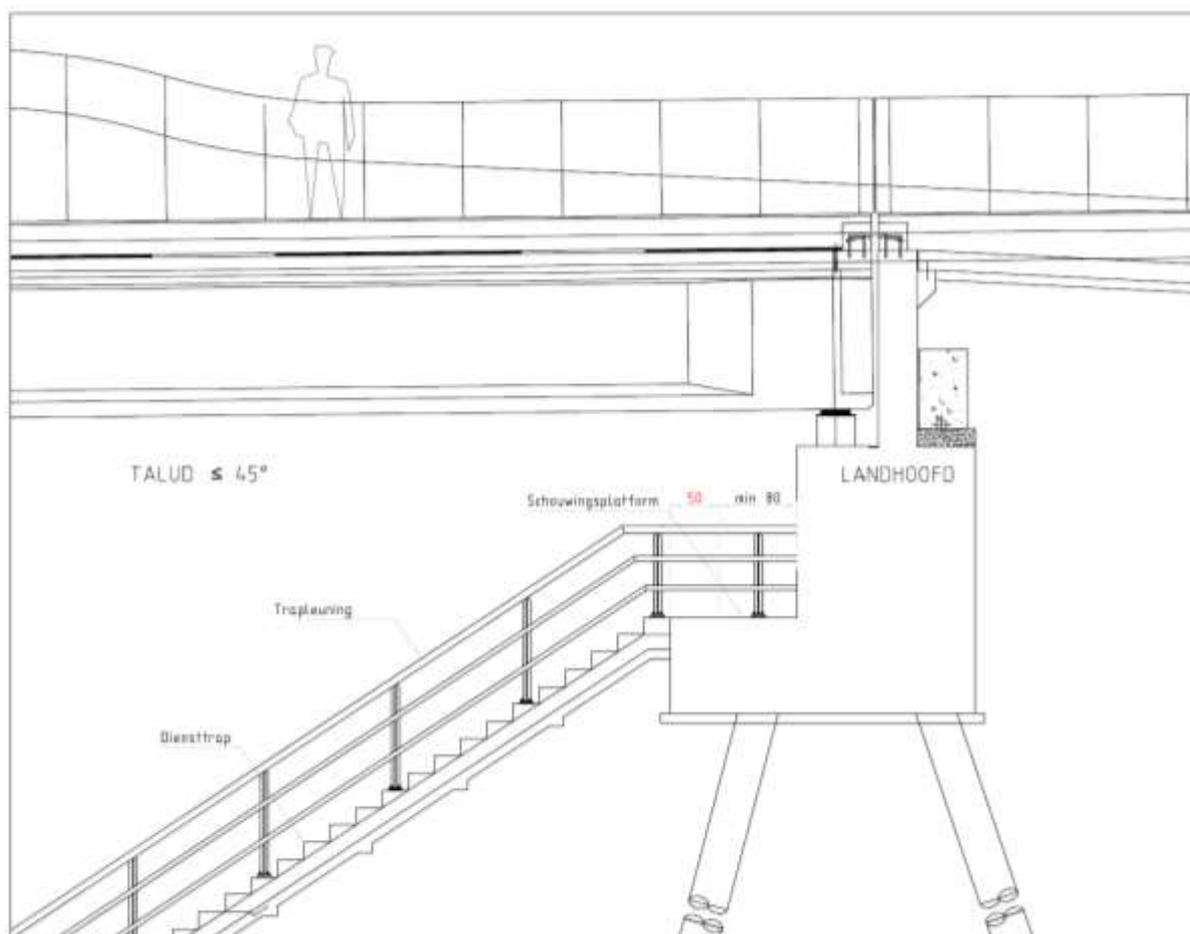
Plate-forme d'inspection de culée noyée en cas de talus doux
